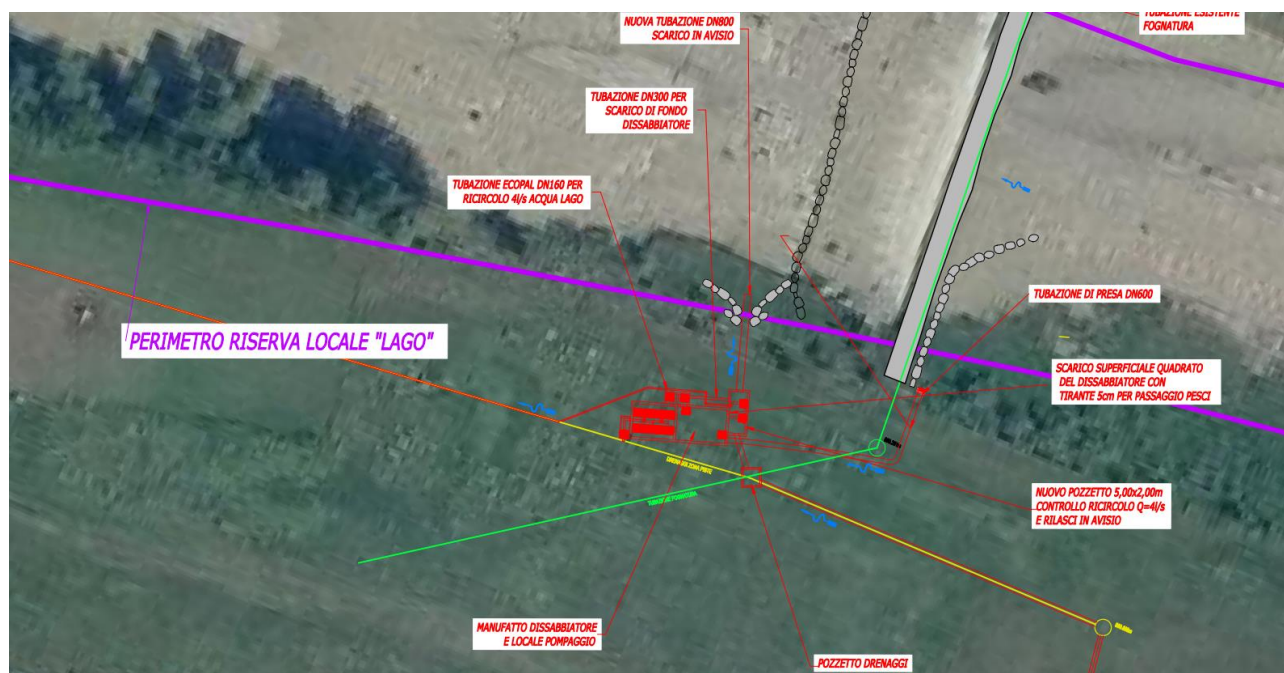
Estratto della planimetria allegata al termine della presente relazione.
